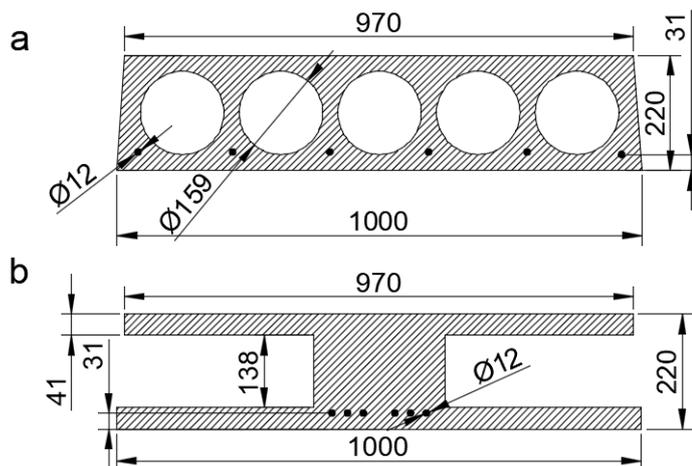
Поперечные сечения железобетонных многопустотных панелей:
